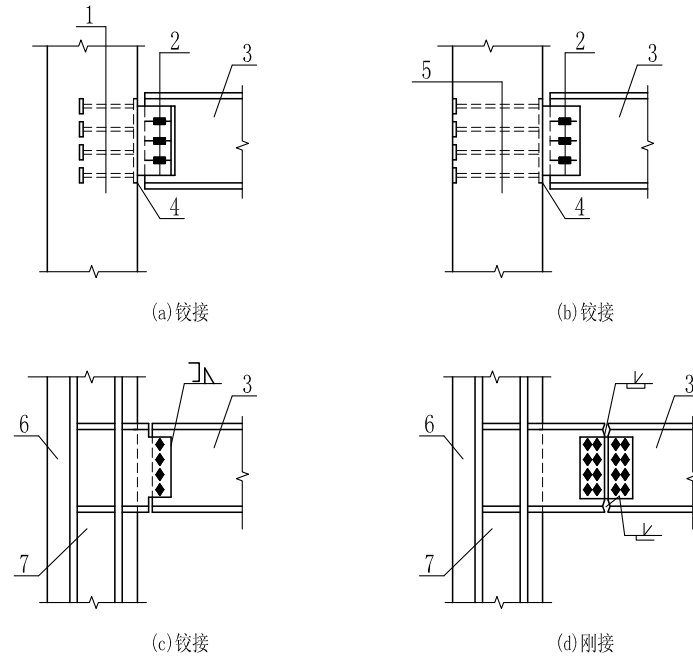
钢梁和型钢混凝土梁与混凝土核心筒的连接构造示意
